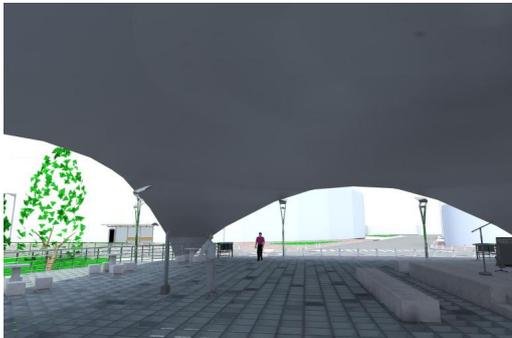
Perspectiva.- Puente Plaza-Monolitos de hormigón.
